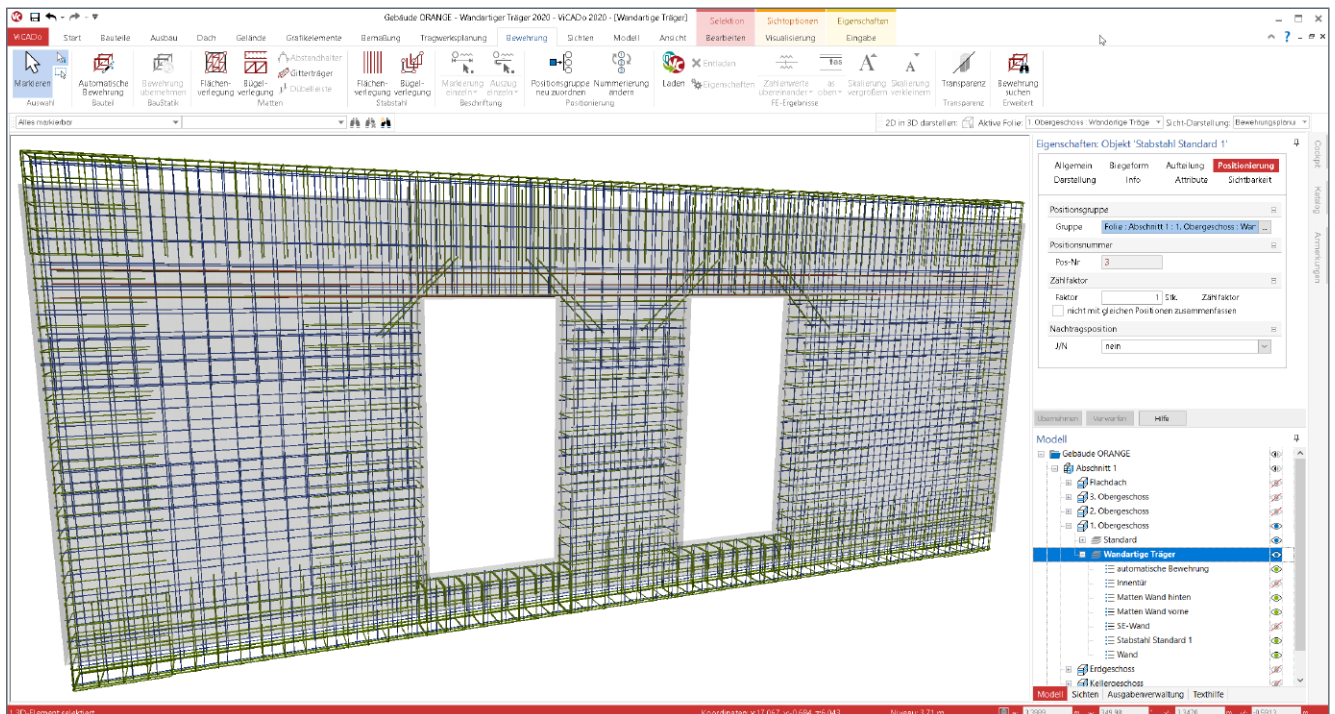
3D-Bewehrung im Bauteil „Wandartige Träger mit Öffnungen“
